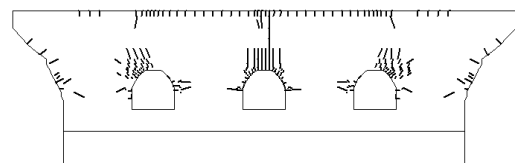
初期ひび割れ状態（材齢 105 日）
